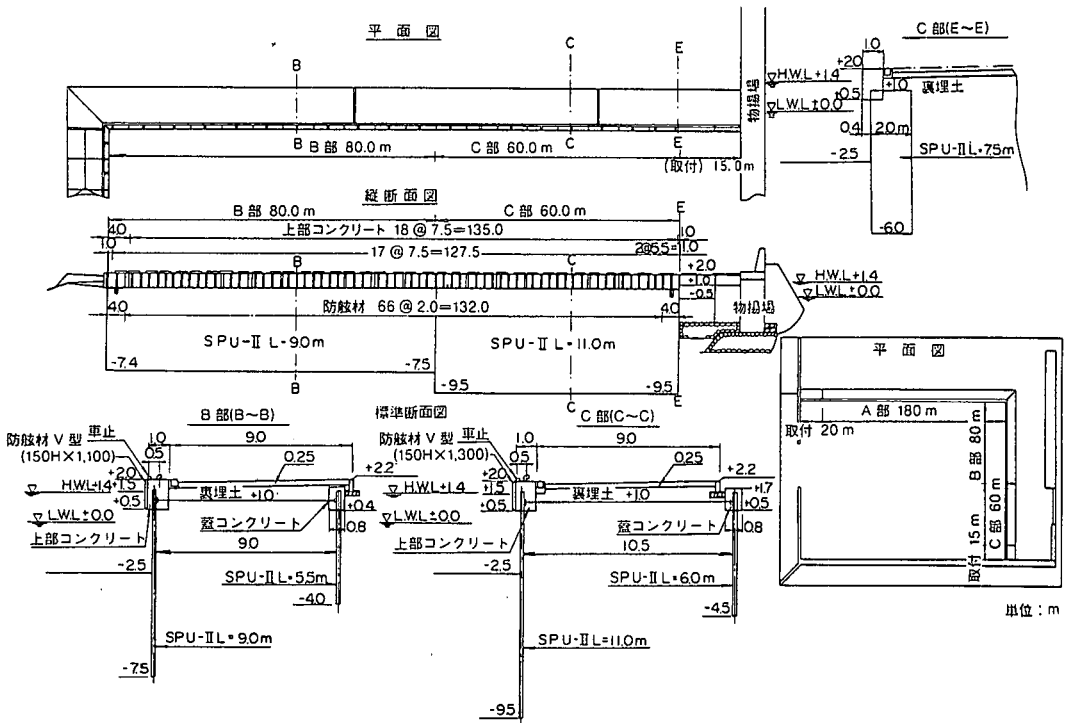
森港西-2.5 m 物揚場平面図・縦断面図・標準断面図
